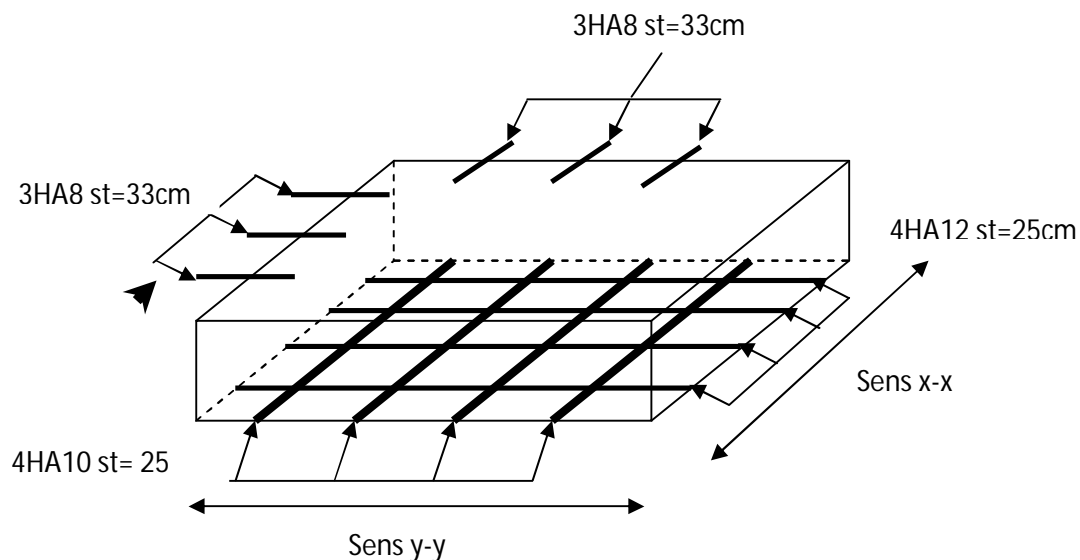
Schéma de ferrailage d'une dalle sur 3
